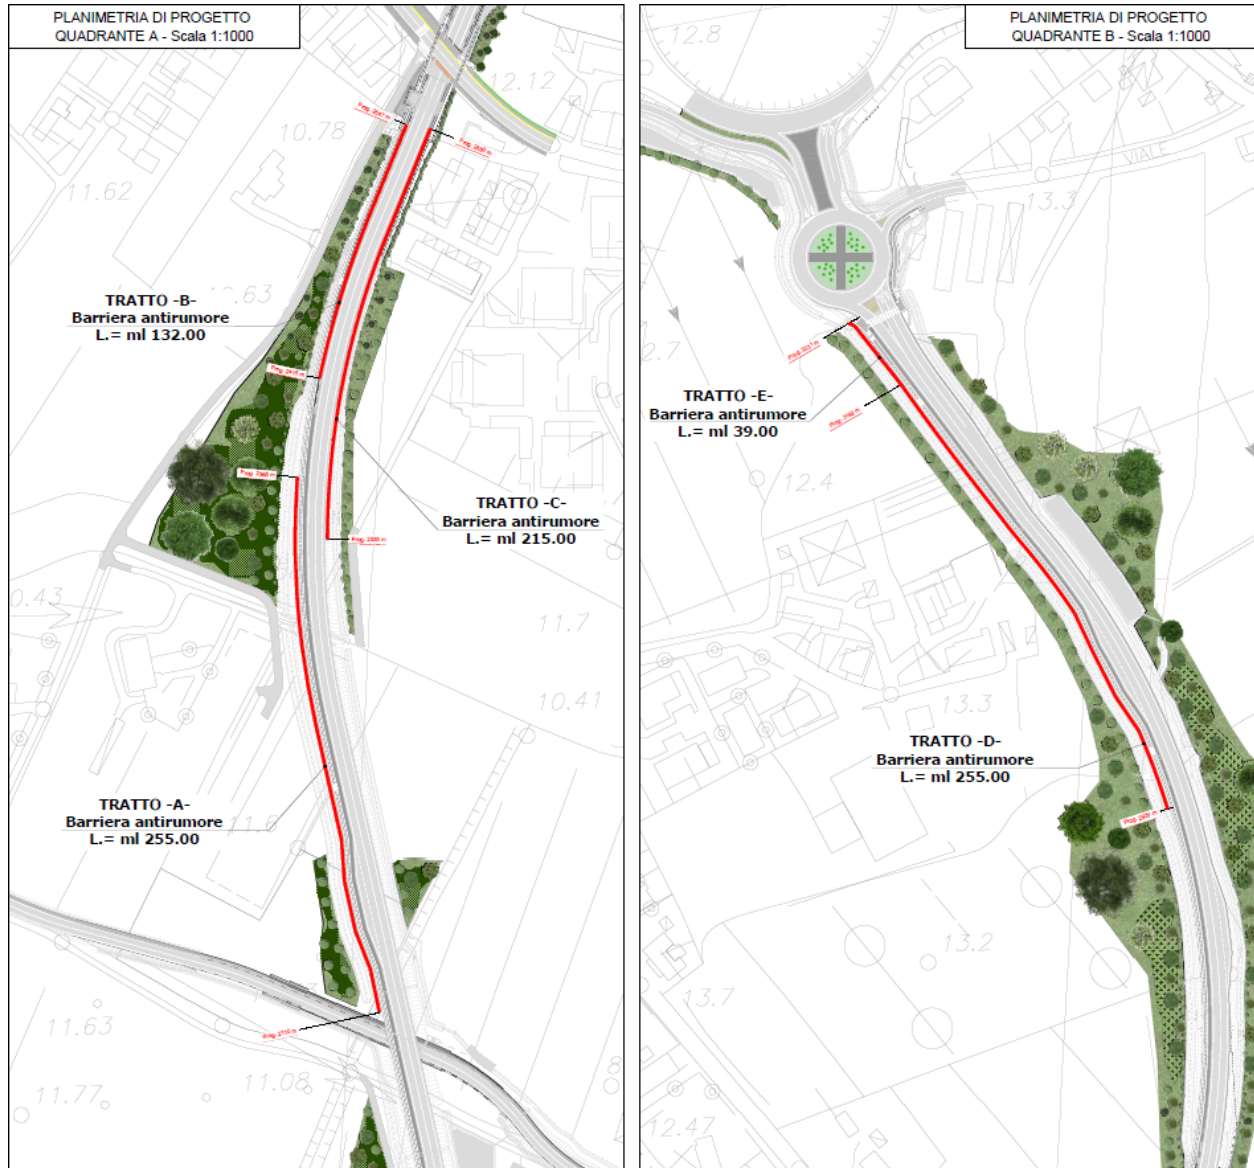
Stralcio planimetrica di progetto opere di mitigazione acustica – Progetto Definitivo
